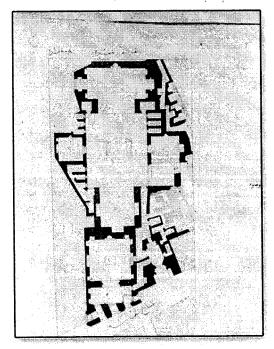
جامع حران (مسقط أفقي) عن : أحمد فكري
